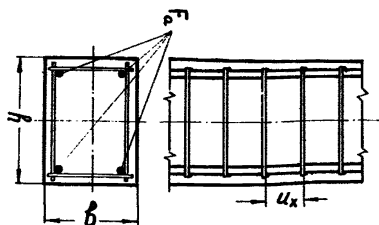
Армирование центрально сжатого сталеполимербетонного элемента.
